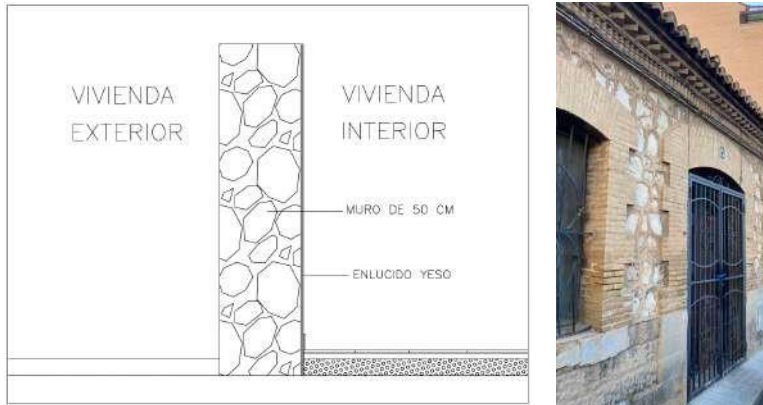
Muro de piedra existente en la vivienda. Fuente propia
